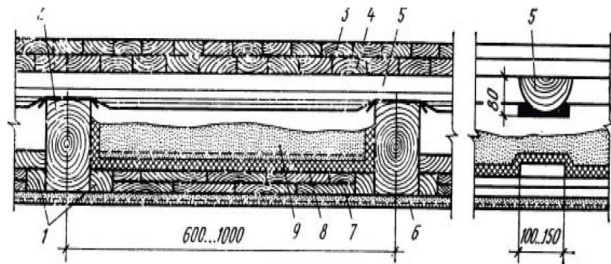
Конструкція дерев'яного міжповерхового перекриття:
